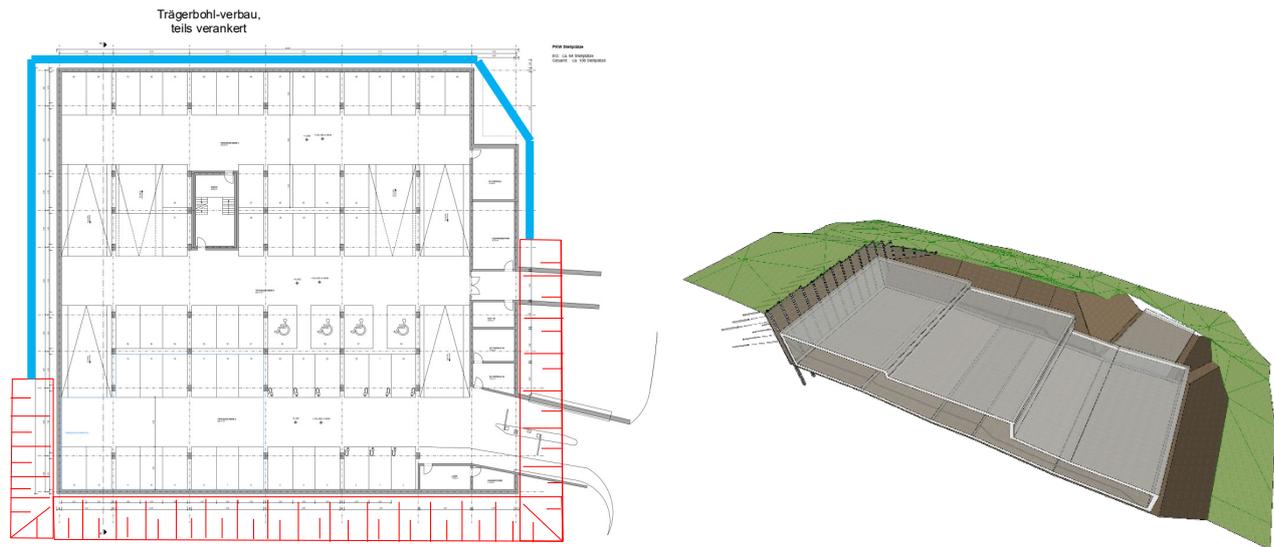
Lageplan Baugrubenempfehlung Brauerei [U 1.7]
